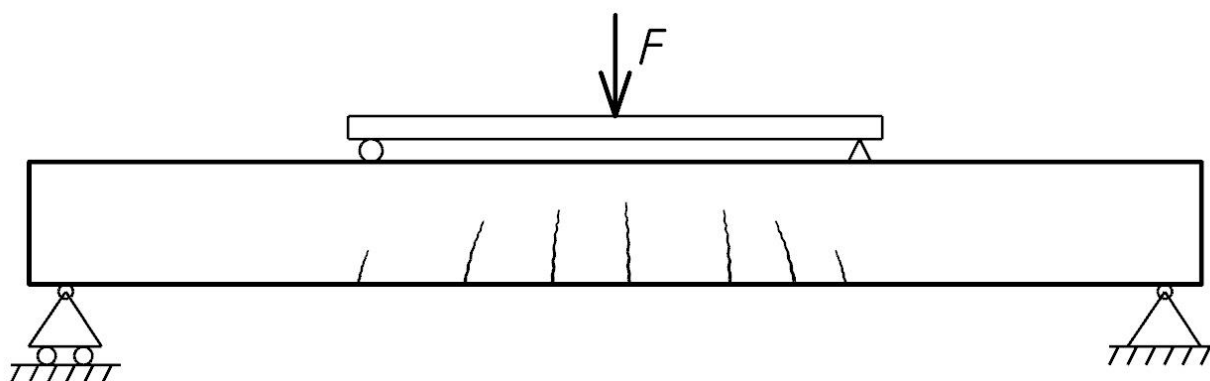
Схема образования силовых трещин в растянутой зоне бетона
